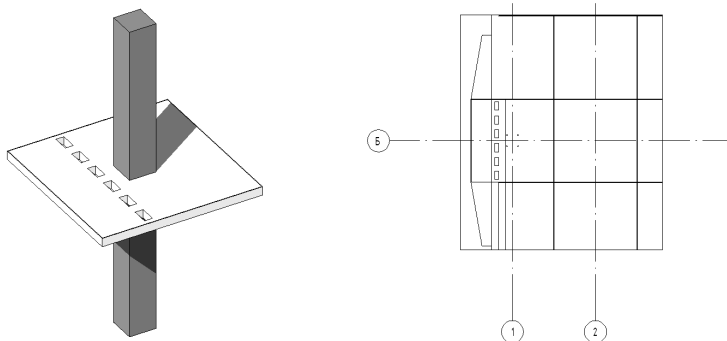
Фрагмент плана межэтажного перекрытия
